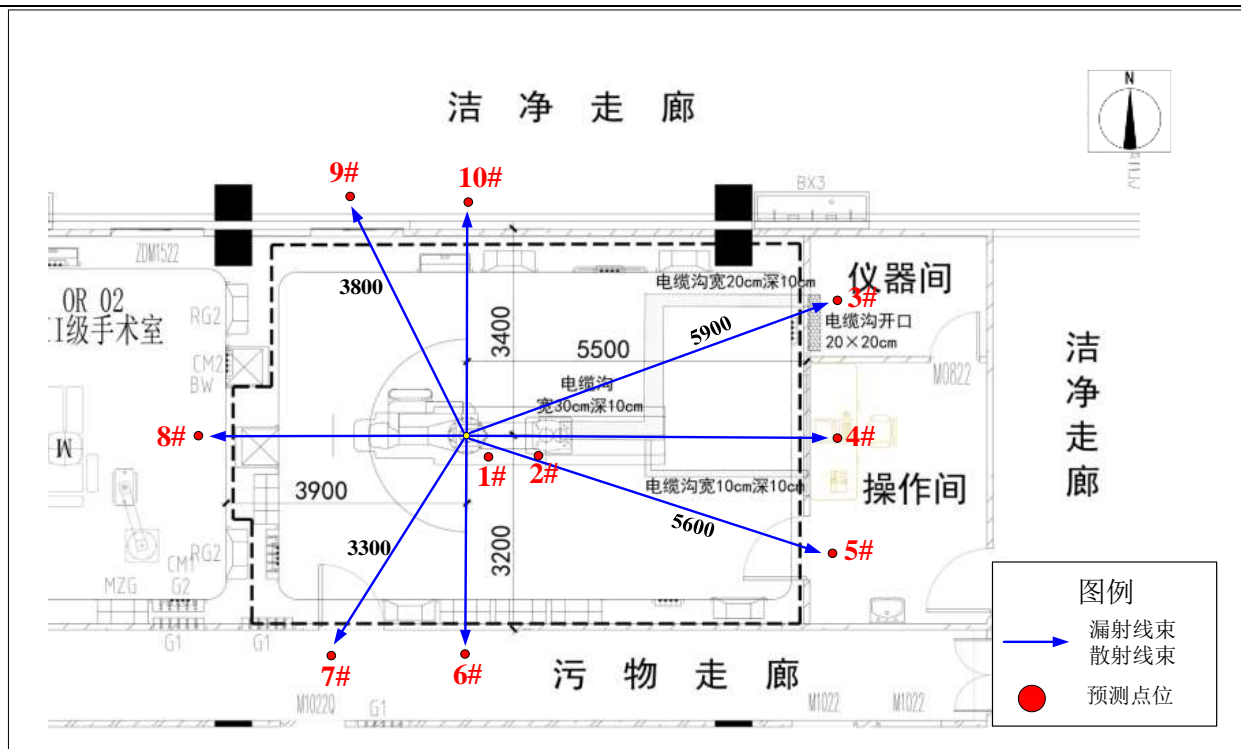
本项目 3 号 DSA 手术室平面布局及预测点位示意图（单位：mm）
